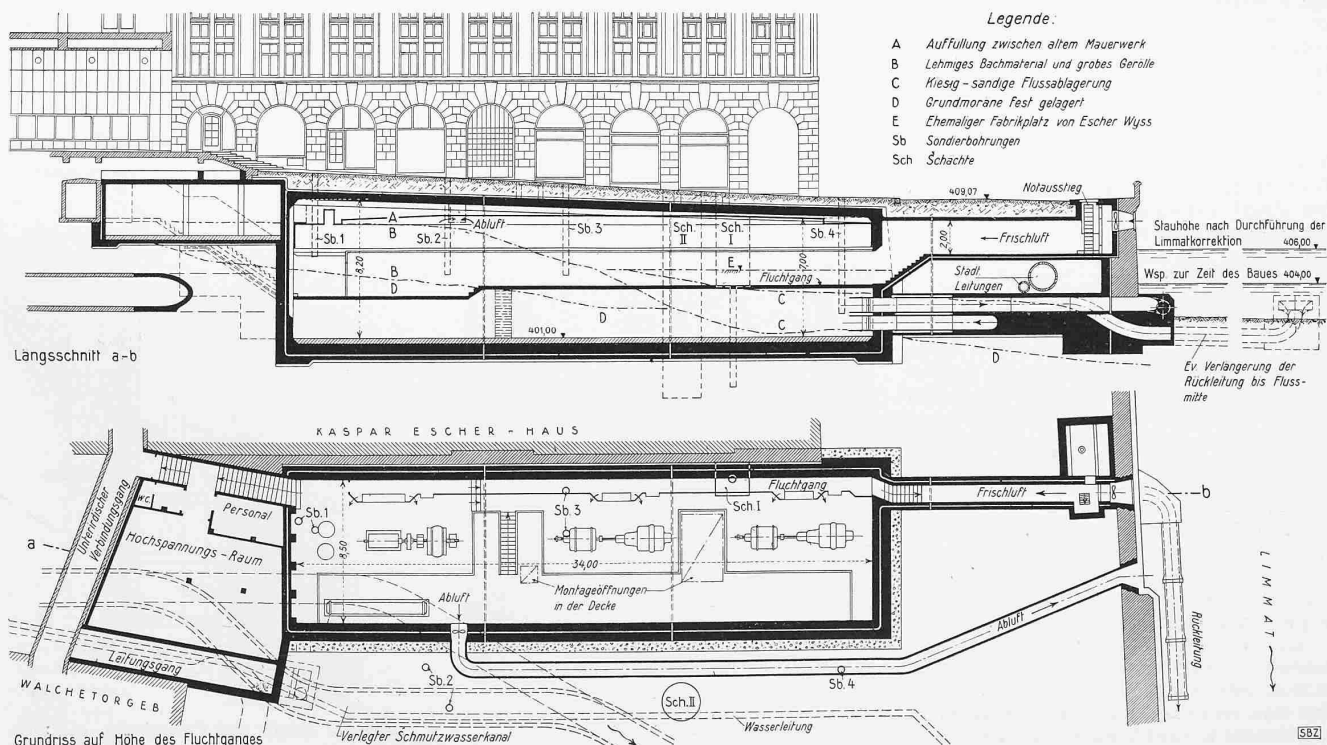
Horizontalschnitt mit Grundriss, darüber Längsschnitt des Wärmepumpenwerkes im Walcheplatz. — Masstab 1:400
